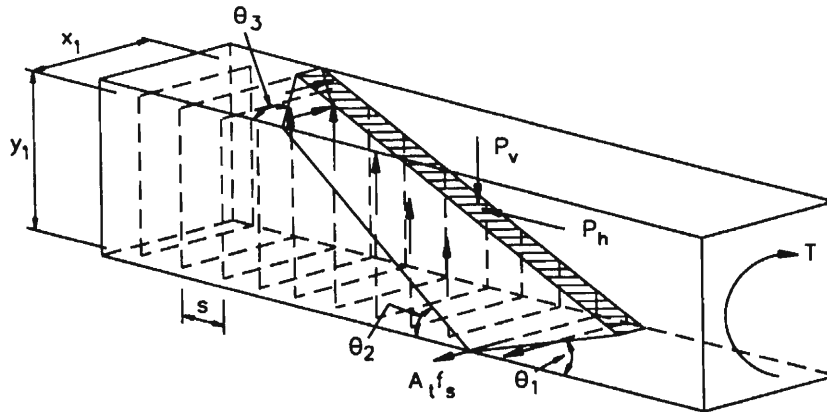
Elemento rectangular de concreto armado sometido a torsión y fuerzas que se generan a través de las fisuras
